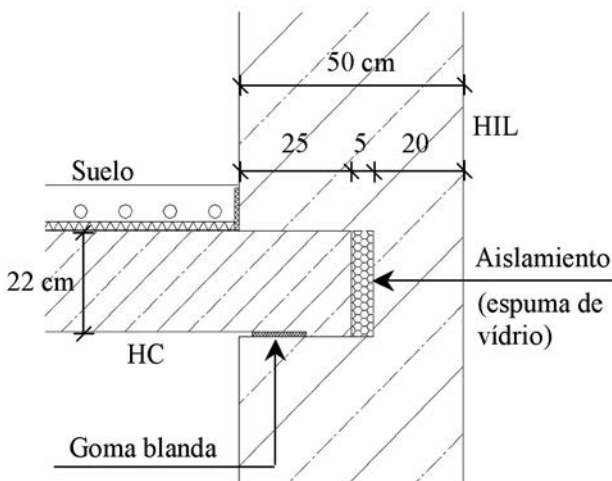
Conexión de la losa de forjado al muro de hormigón infraligero con barras de fibra de vidrio verticales.
